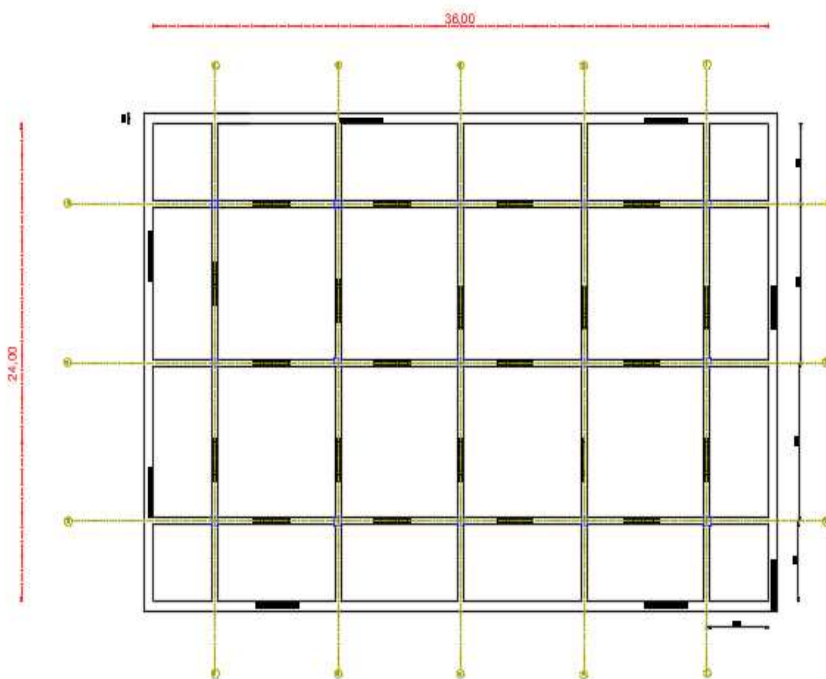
Plano de planta tanque. Fuente: Elaboración propia Programa Autocad.
